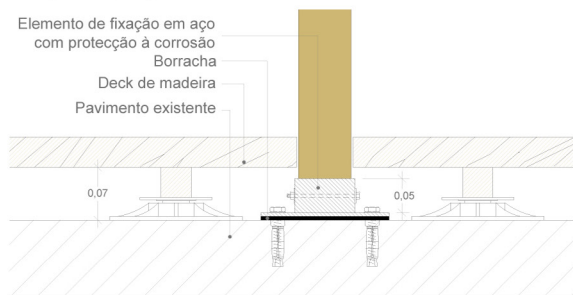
Localização e pormenorização construtiva das floreiras 4 e 5.
